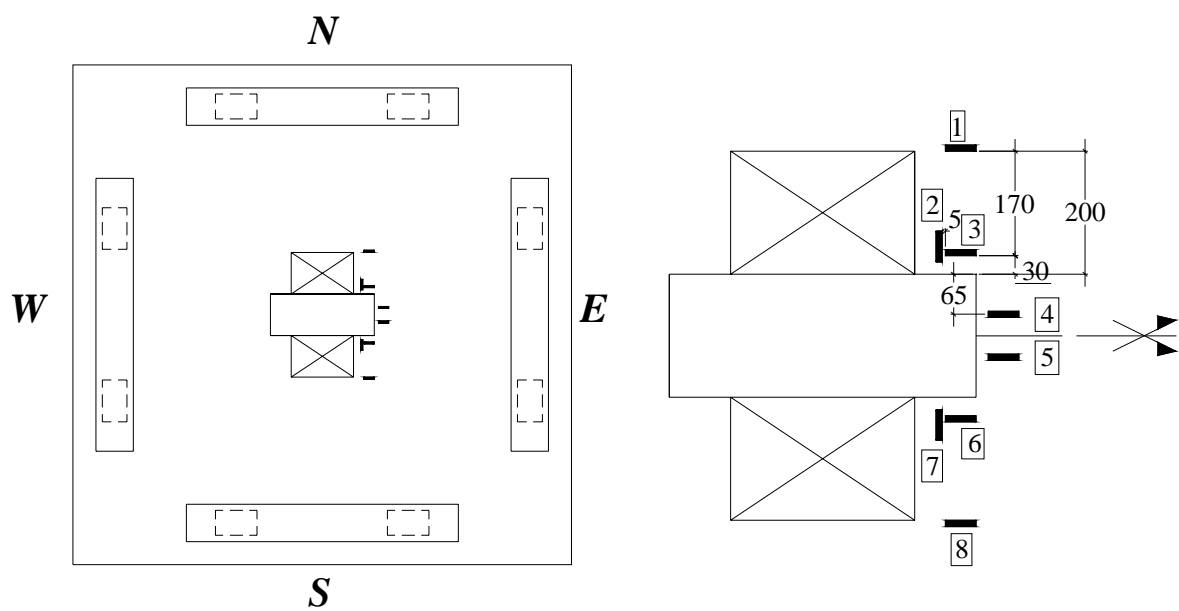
Posicionamento dos EERs do concreto na laje L18 (mm)
